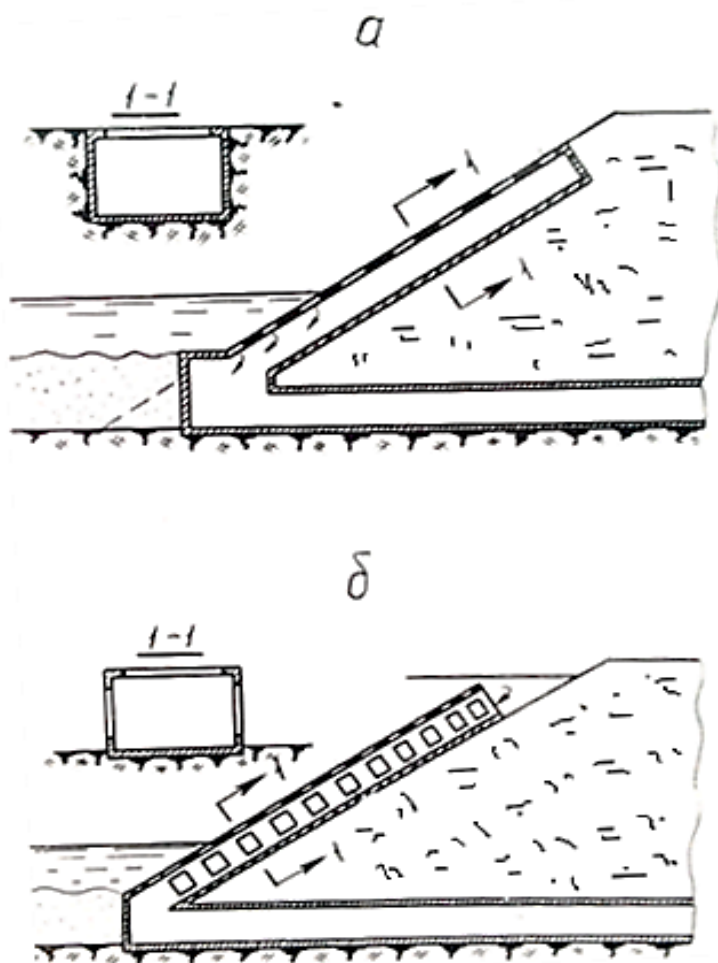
Видовыпуски с водоприемной шахтой, размещенной на верхнем откосе плотины.
